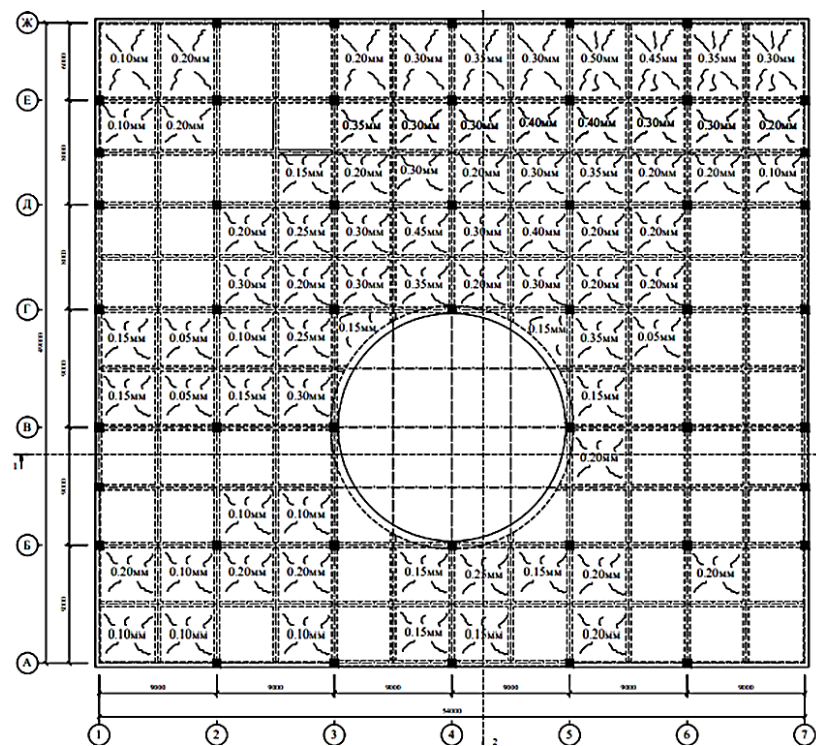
Схема расположения трещин в плите покрытия в крыше подземного здания
